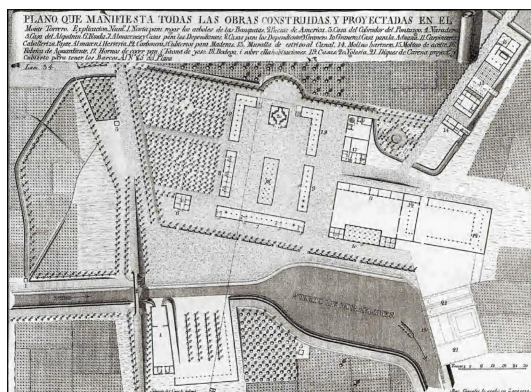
Plano del puerto de Miraflores, Tiburcio del Caso, 1794.
